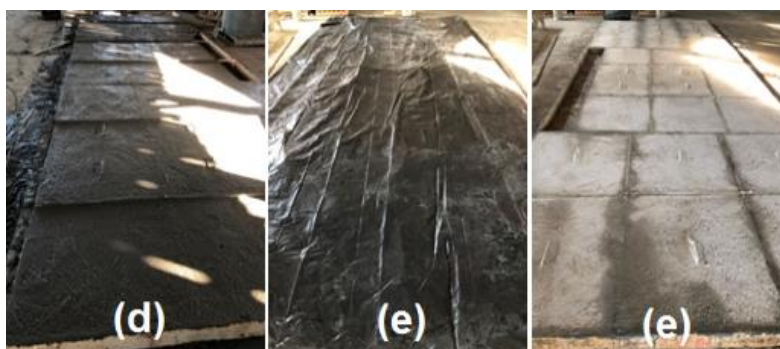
(d) Concretagem das lajes; (e) Processo de cura das lajes.
